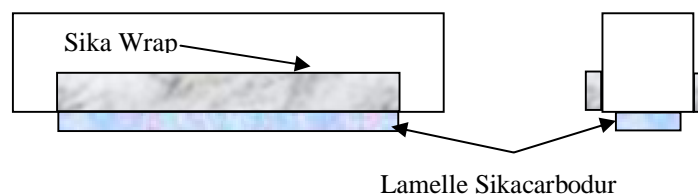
Renforcement poutre par Sika Carbodur et sika wrap
